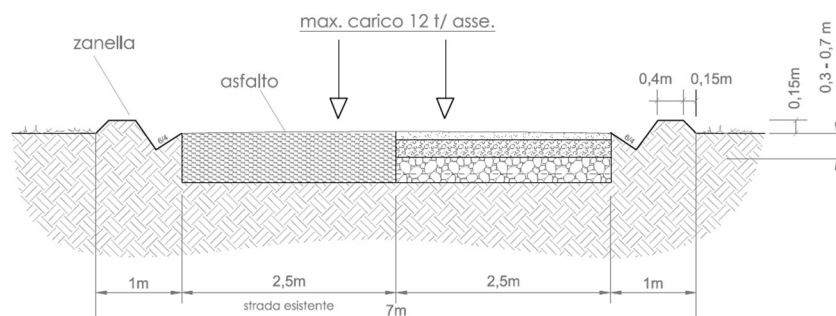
Sezione stradale tipo nel caso di allargamento della sede stradale esistente
